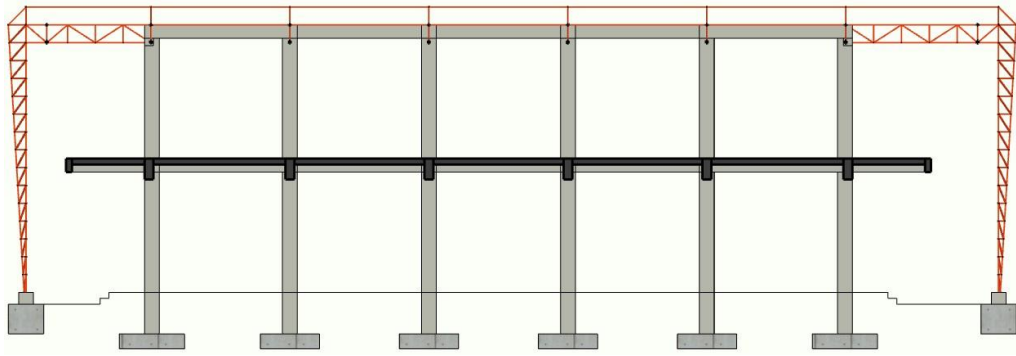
Vista de elevación lateral - Pórticos y estructura metálica.
